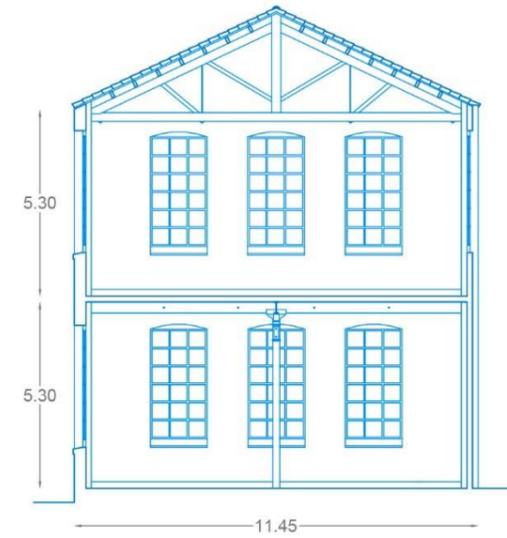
PLANO 1/200. Sección transversal pre intervención nave original fábrica Tort Can Planell. Fuente: Elaboración propia.
